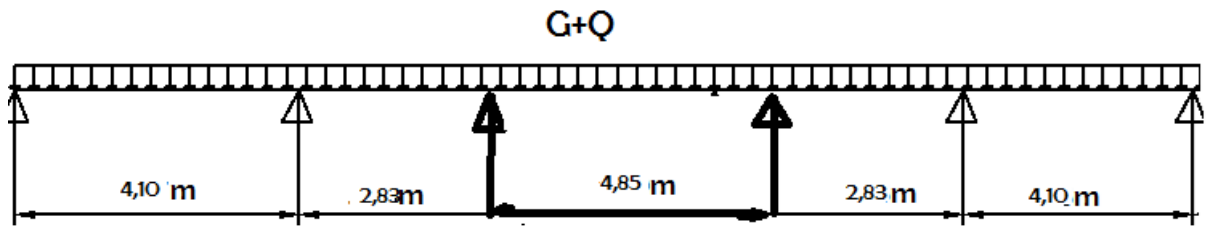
Schéma statique de Poutrelle à cinq travées.
